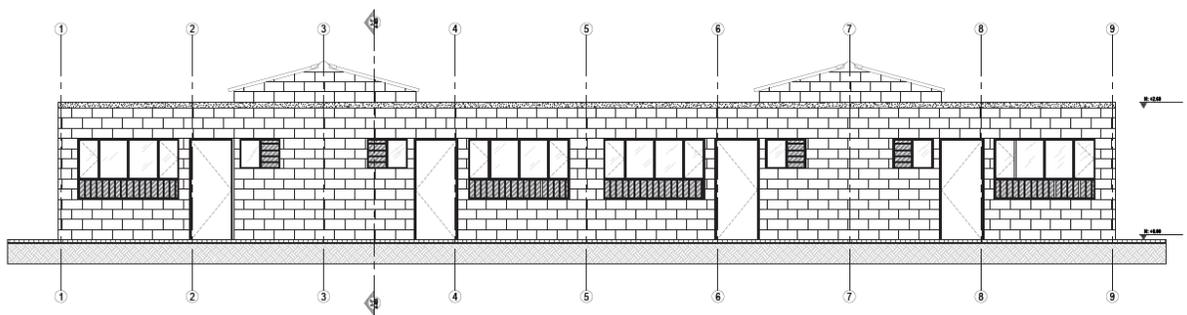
Fachada frontal vivienda con ampliación - VIP
